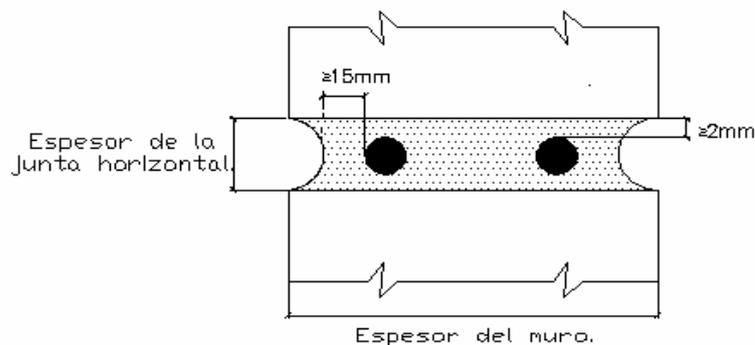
Recubrimientos de las armaduras en junta horizontal
